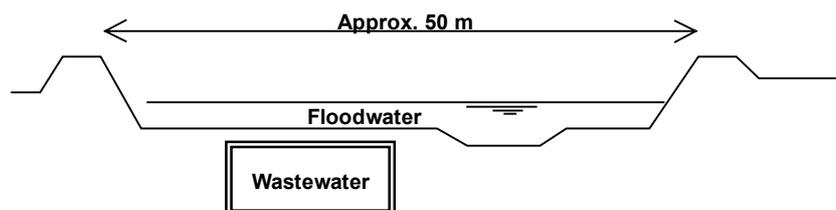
Sección Transversal del Río Juan Amarillo / Sistema Box Culvert del Salitre
